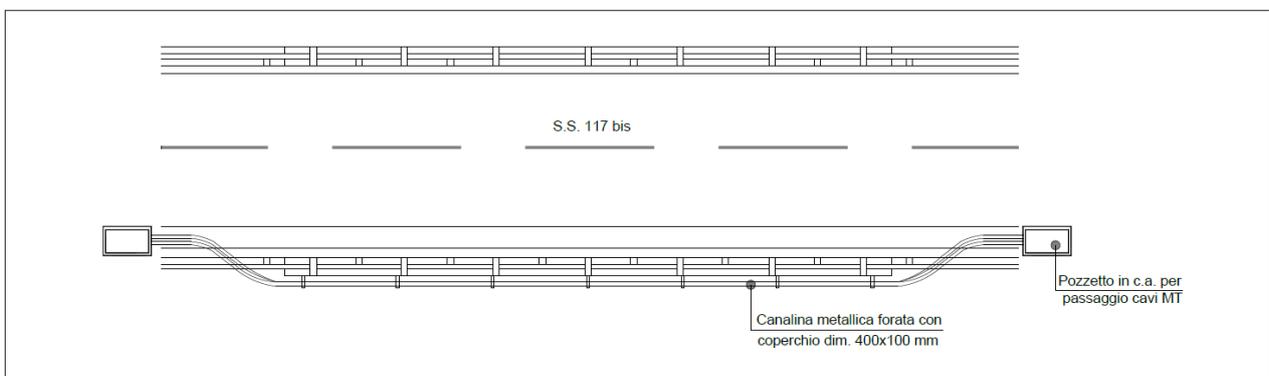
Attraversamento idraulico n.3 (Vallone dello stretto) – Schema di progetto in pianta
